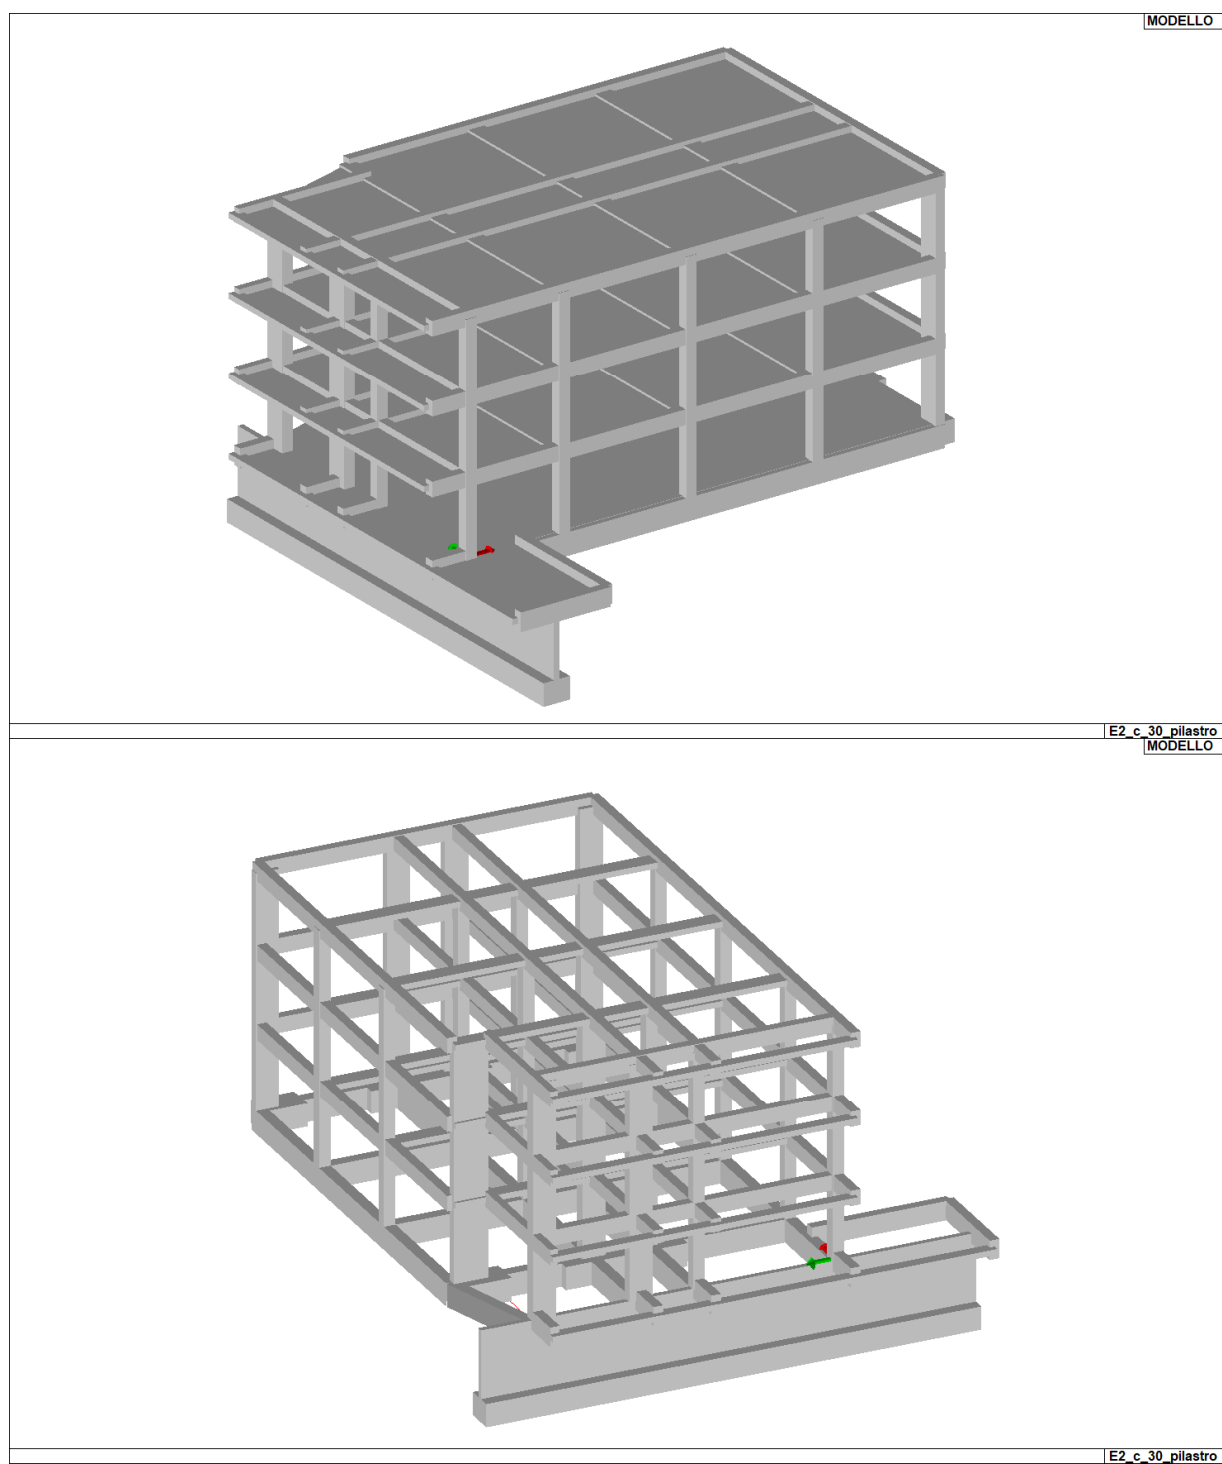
Vista assometrica modello struttura in elevazione – comprensivo di solai
